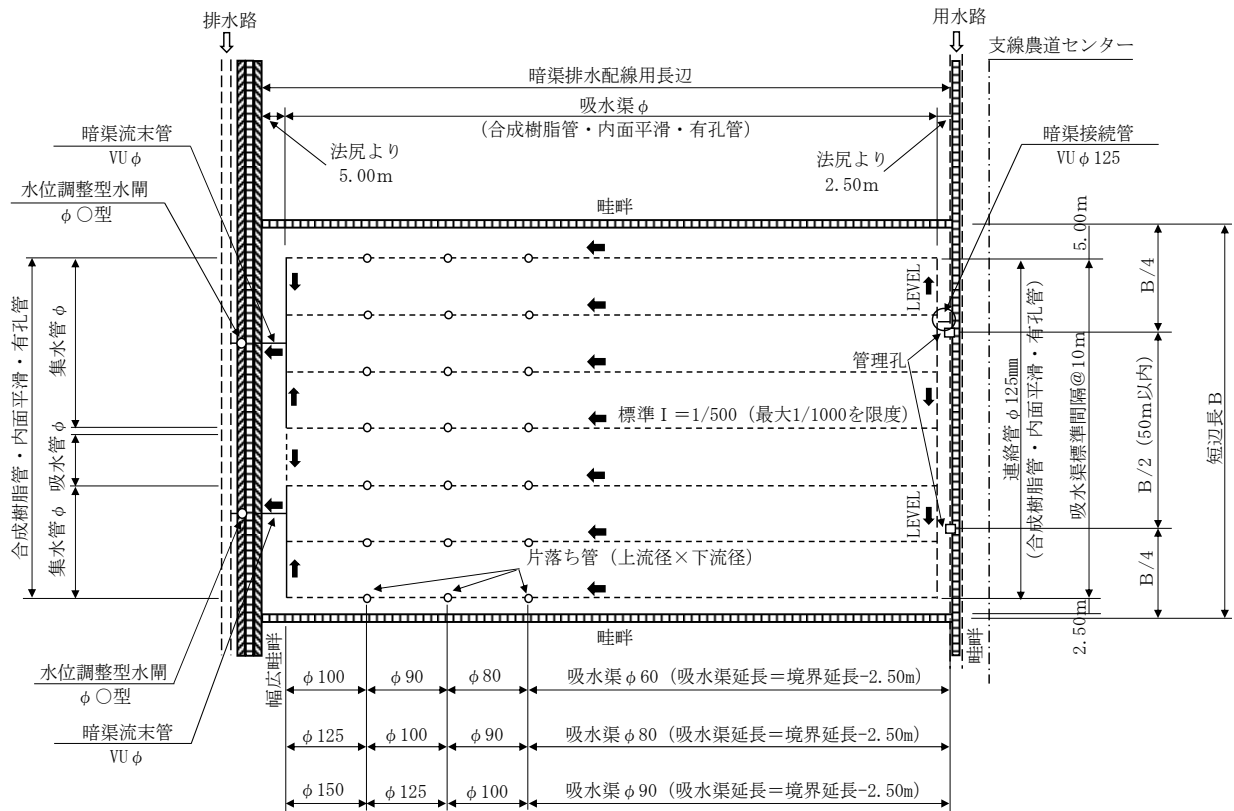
暗渠排水組織平面図 (水田・汎用田) の例
